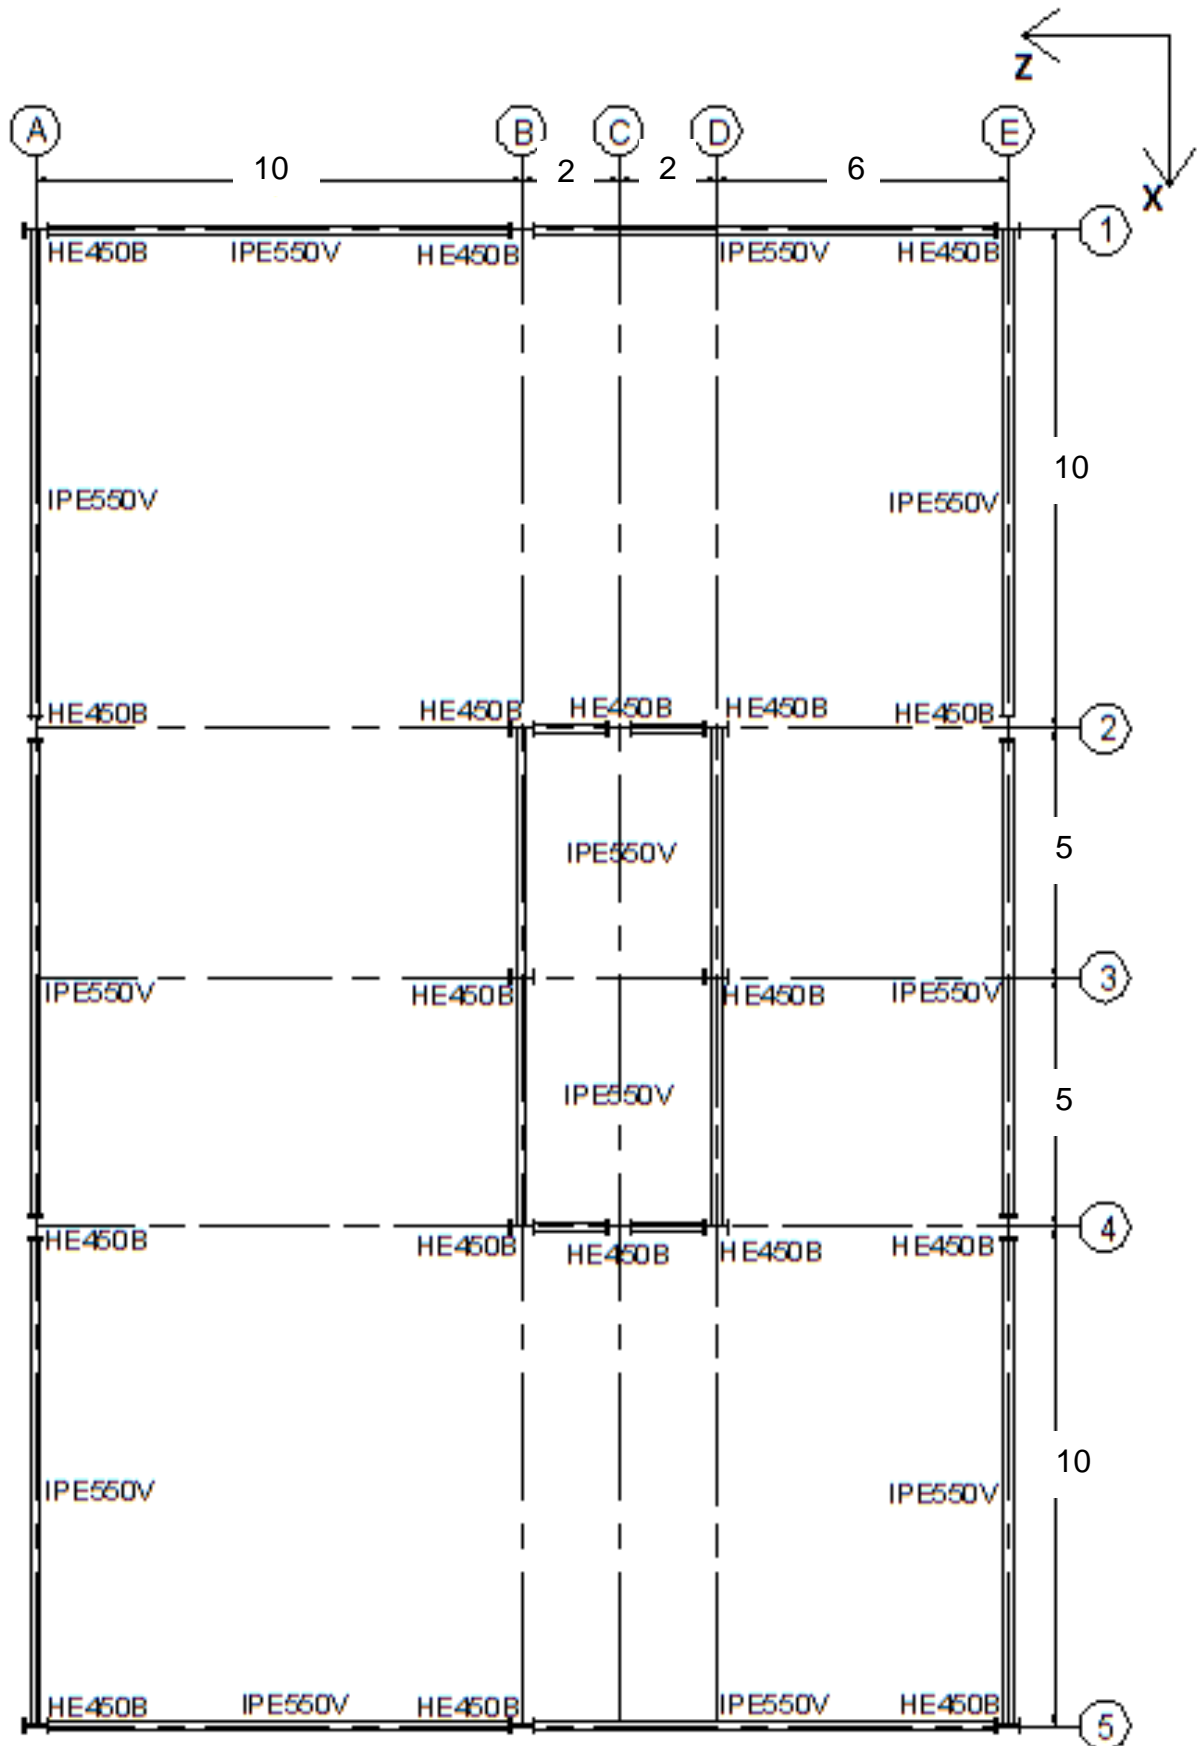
Planta do 1º ao 10º pavimento. As medidas estão em metros.
